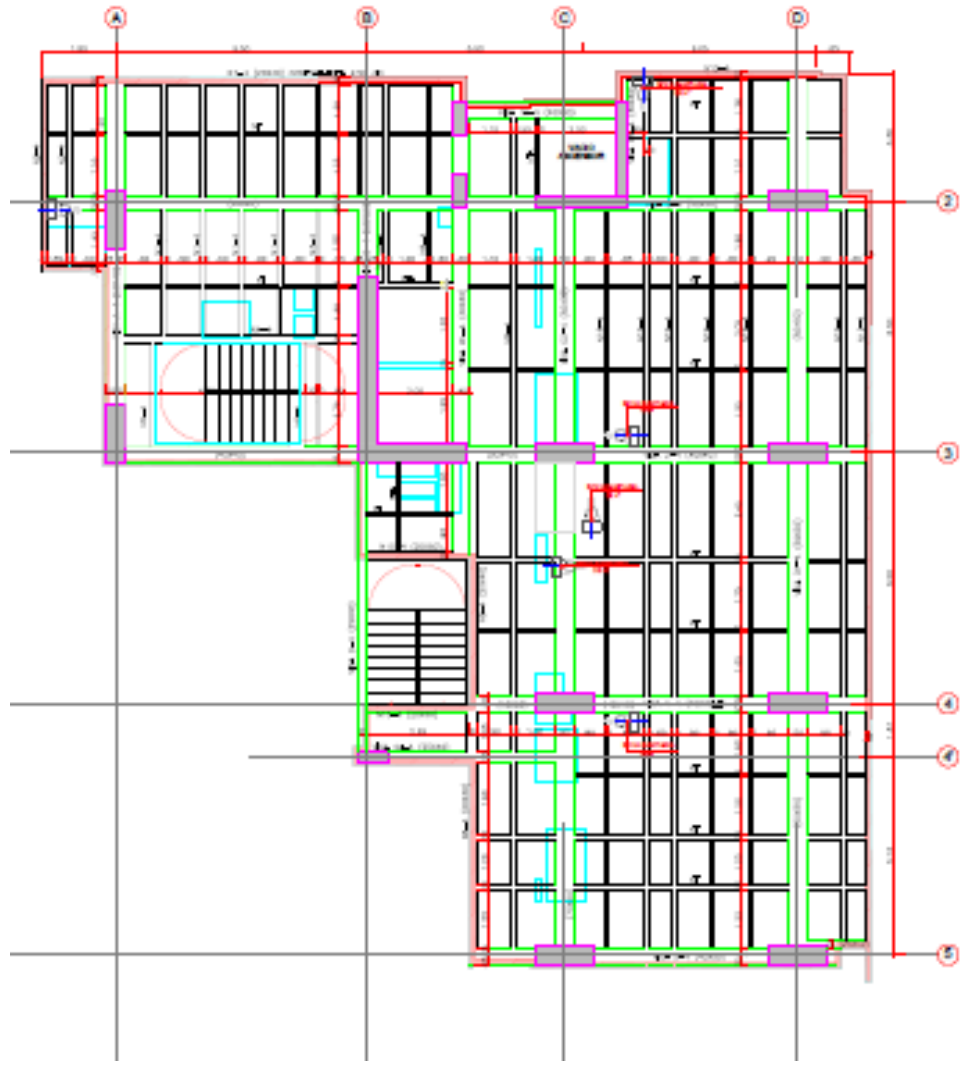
Vista en planta del piso típico 2 (Pisos 7, 12 y 17)
